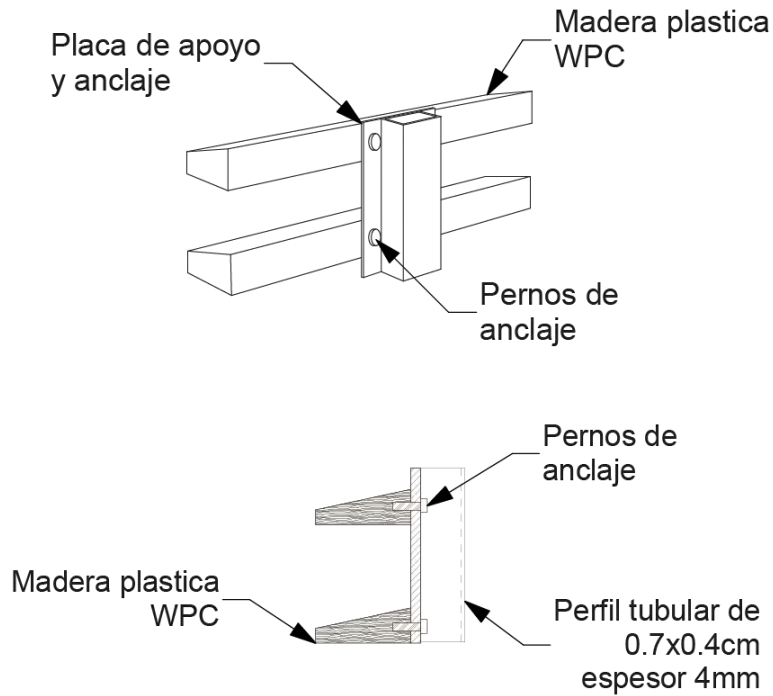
Detalles conexiones fachadas. Fuente: Elaboración Propia.
